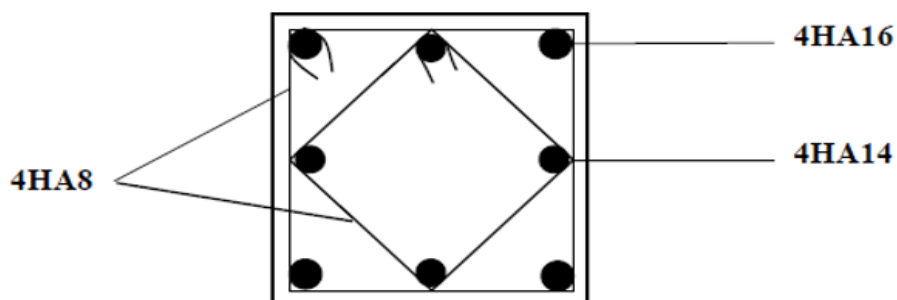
Schéma de ferrailage des poteaux 4.5.6<sup>ème</sup> étages
